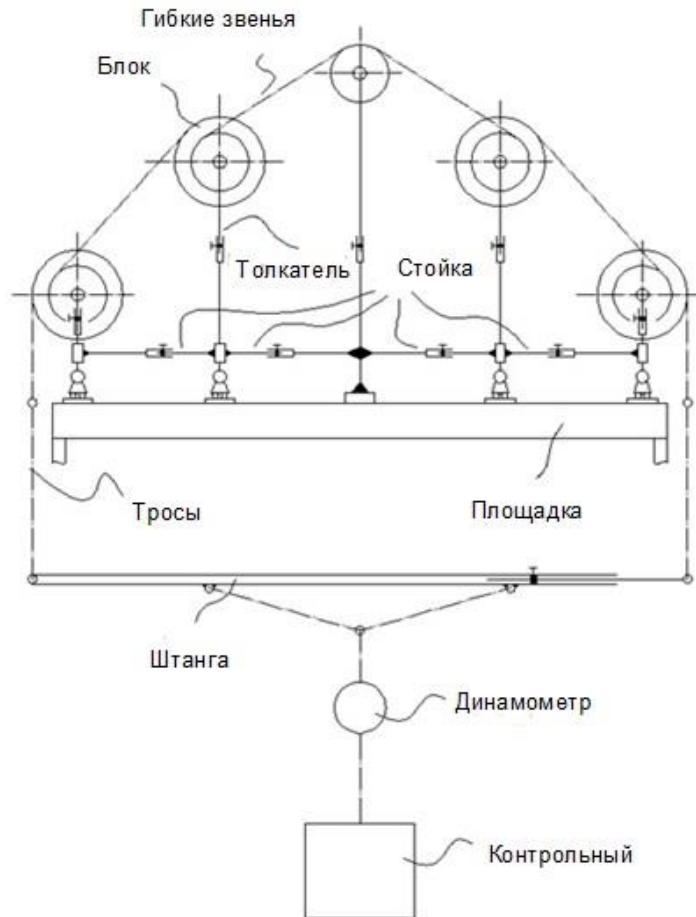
Устройство для испытания площадок пожарных стационарных маршевых лестниц
